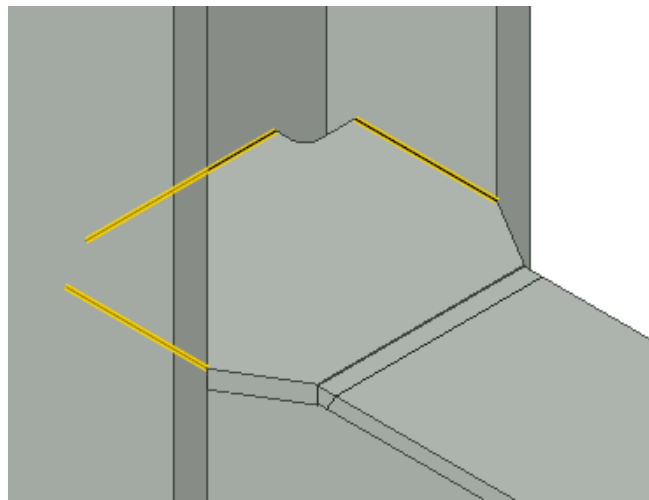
Agrietamiento en soldadura de penetración total en FF-W
